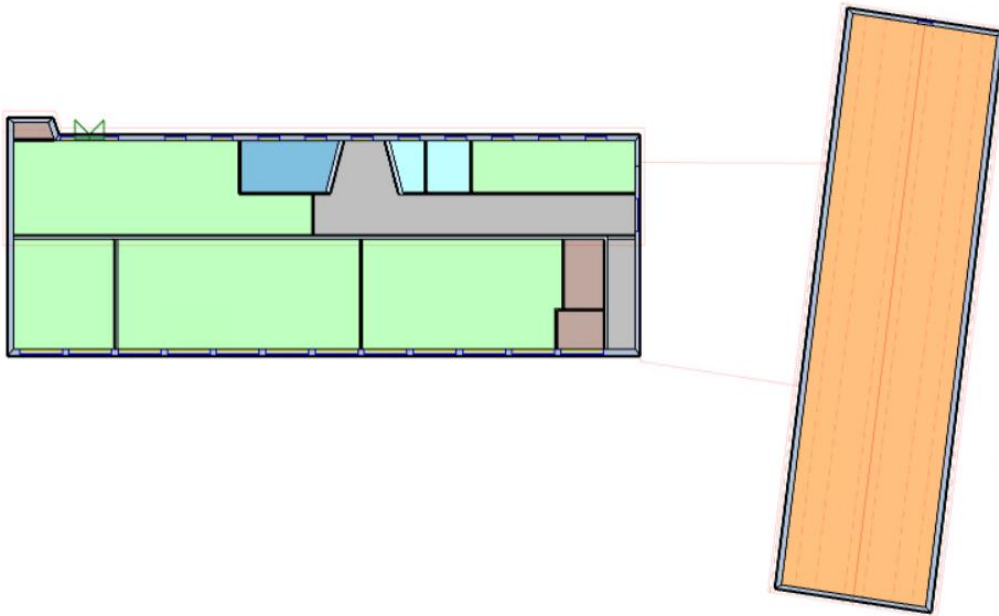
Grundriss Obergeschoss, zoniert
